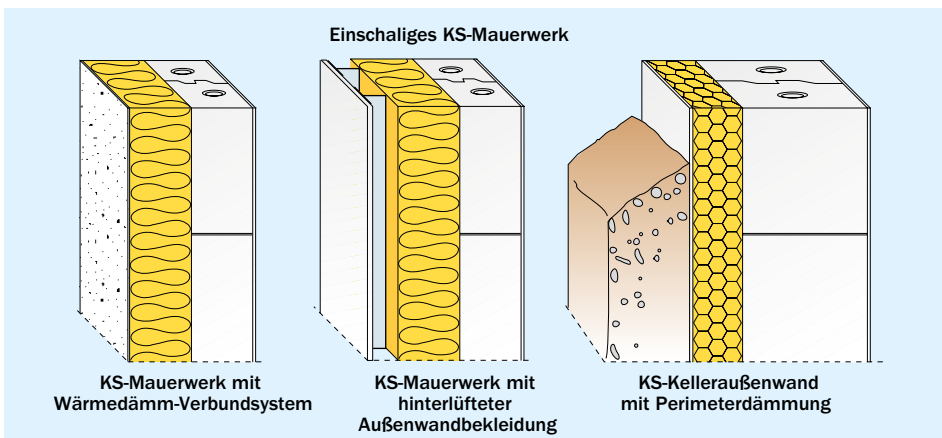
Einschalige KS-Außenwandkonstruktionen für beheizte Gebäude
